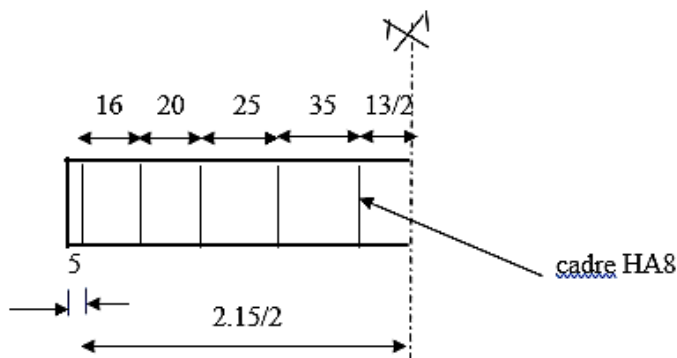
Disposition des armatures transversales (poutre palière)
